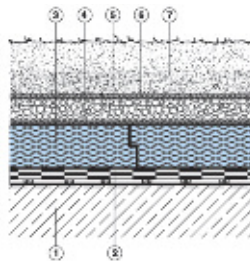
1 – основание кровли, ж/б плита; 2 – гидроизоляция; 3 – утеплитель STYROFOAM 300A; 4 – геотекстиль; 5 – гравий; 6 – геотекстиль; 7 – грунт
